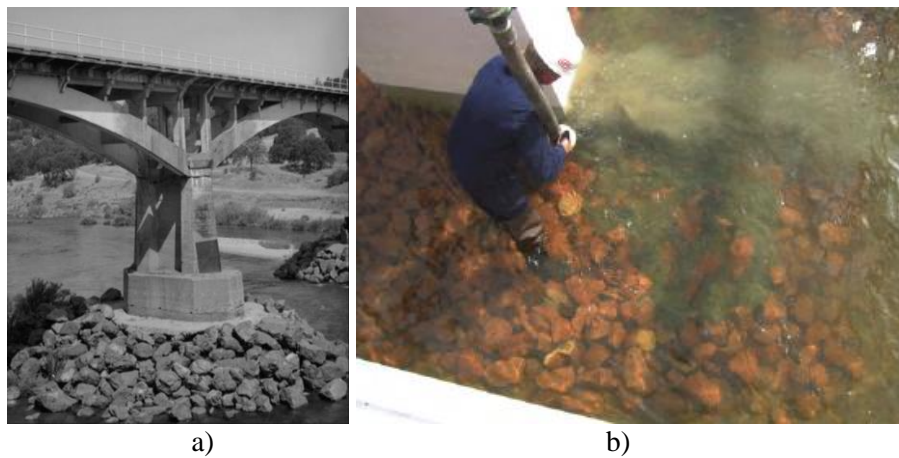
Protección en pilas de puentes con (dominio público de internet): (a) solo enrocamiento y (b) reforzado con concreto.
